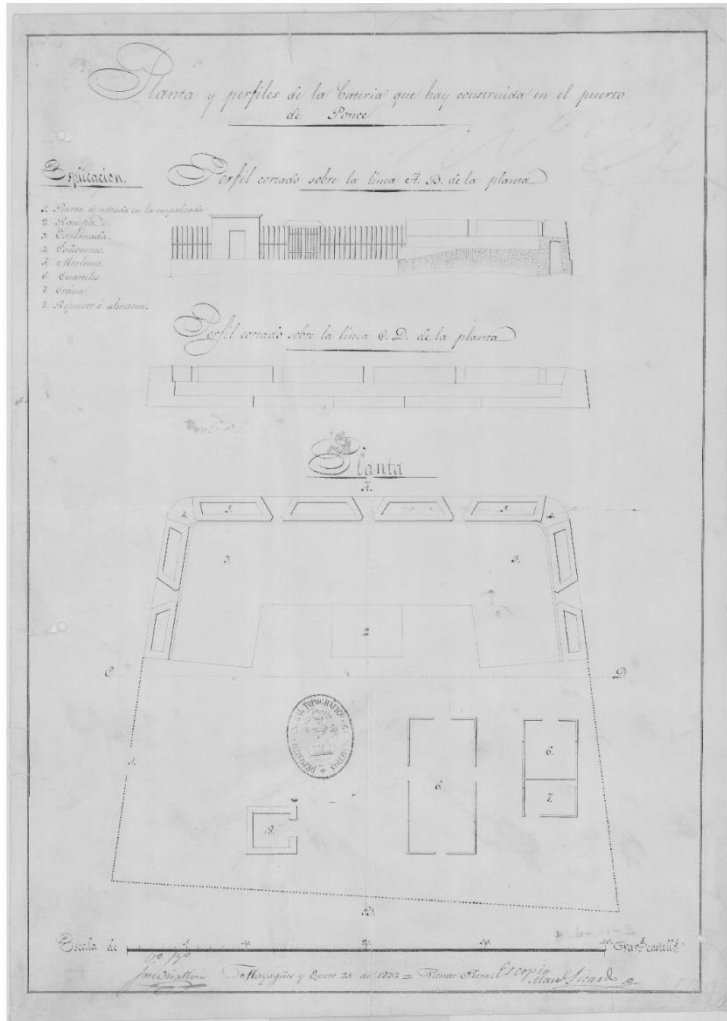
Planta y perfiles de la batería que hay construida en el puerto de Ponce. AGMM, Cartoteca, sig. PRI-15/1
